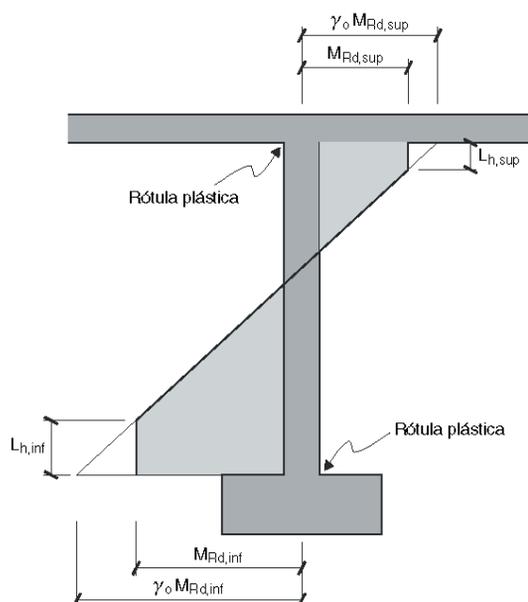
Distribución de momentos por capacidad M_C para pilas en ménsula y pilas empotradas
